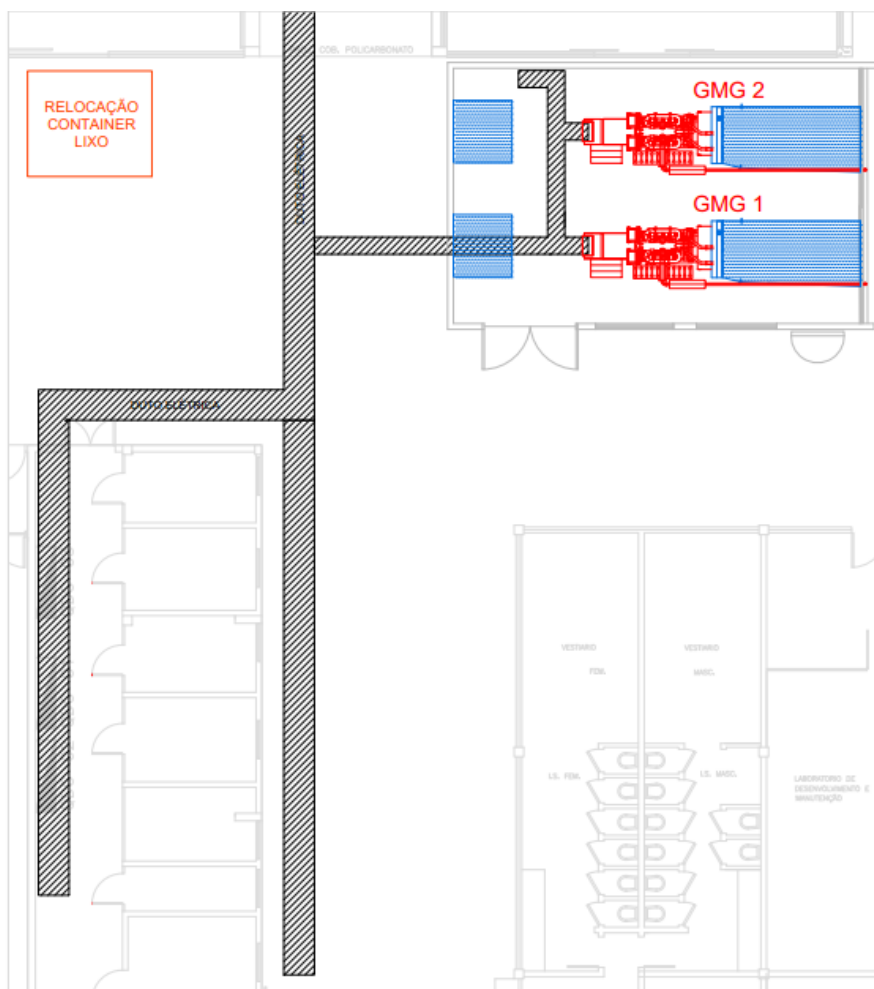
Implantação dos GMG's Primeiro Pavimento
